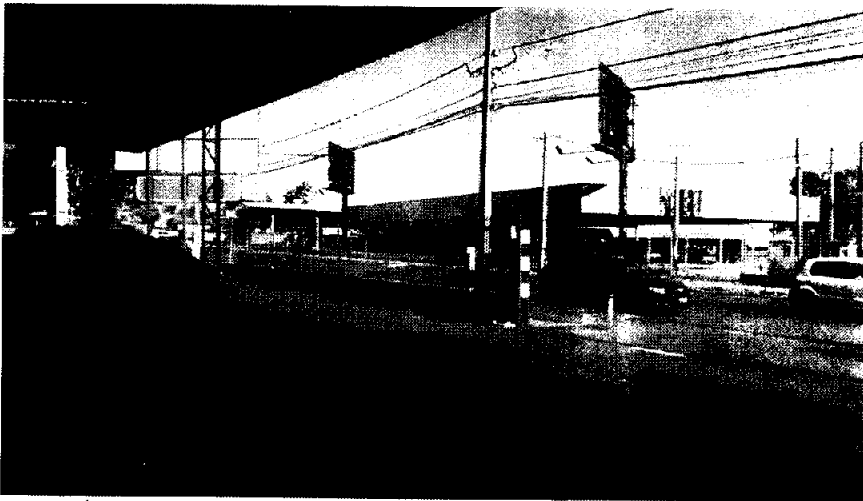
Área frontal do Terreno com vista para a Av. Rocha Pombo
